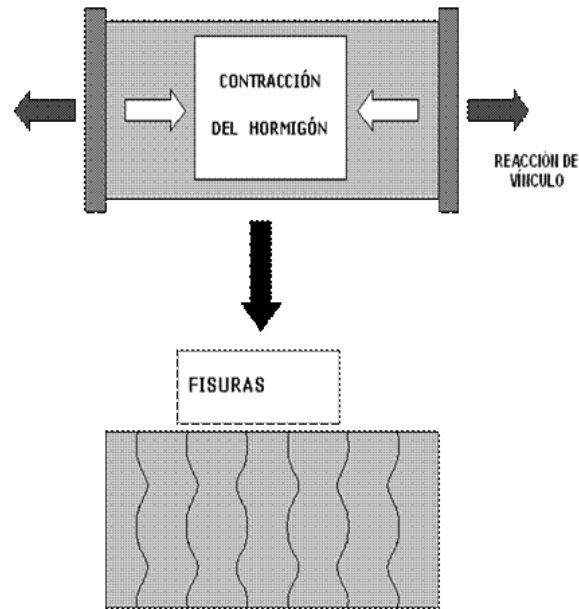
Fisuración por efecto de la contracción impedida
